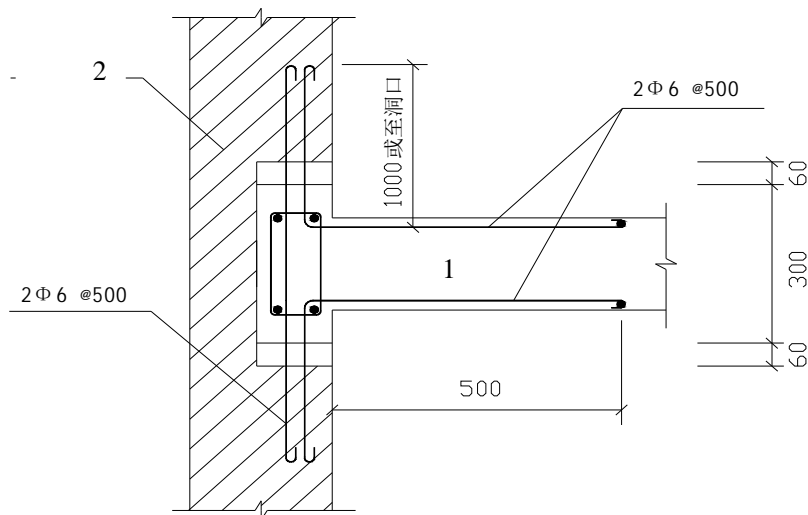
剪力墙钢筋与外砖墙连接构造示意图
